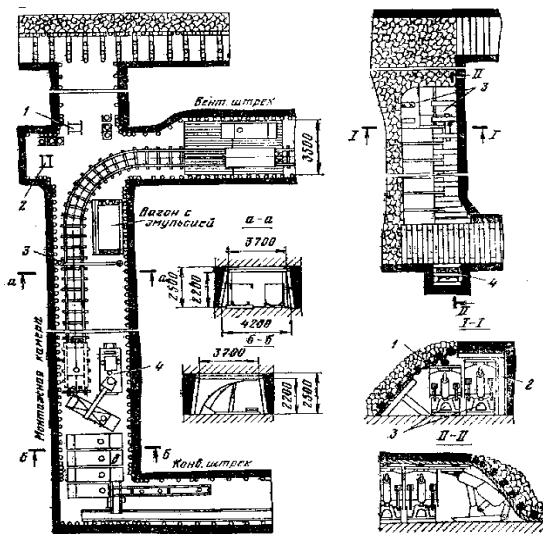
Технологическая схема монтажа комплекса на пластах мощностью свыше 2,0м: а – монтаж, б – демонтаж
